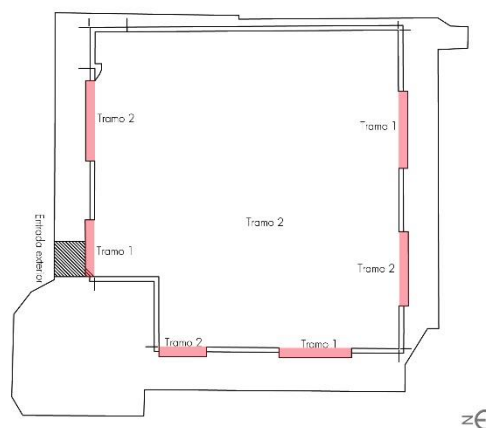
Planta del castillo de Trebujena. Disposición de los tramos de muros originales a conservar.
